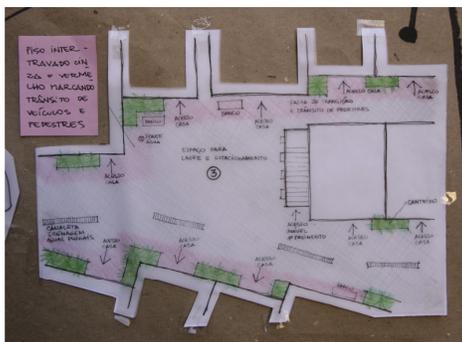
e 7 - Propostas: jardins de garrafa pet e soluções de drenagem e pavimentação
